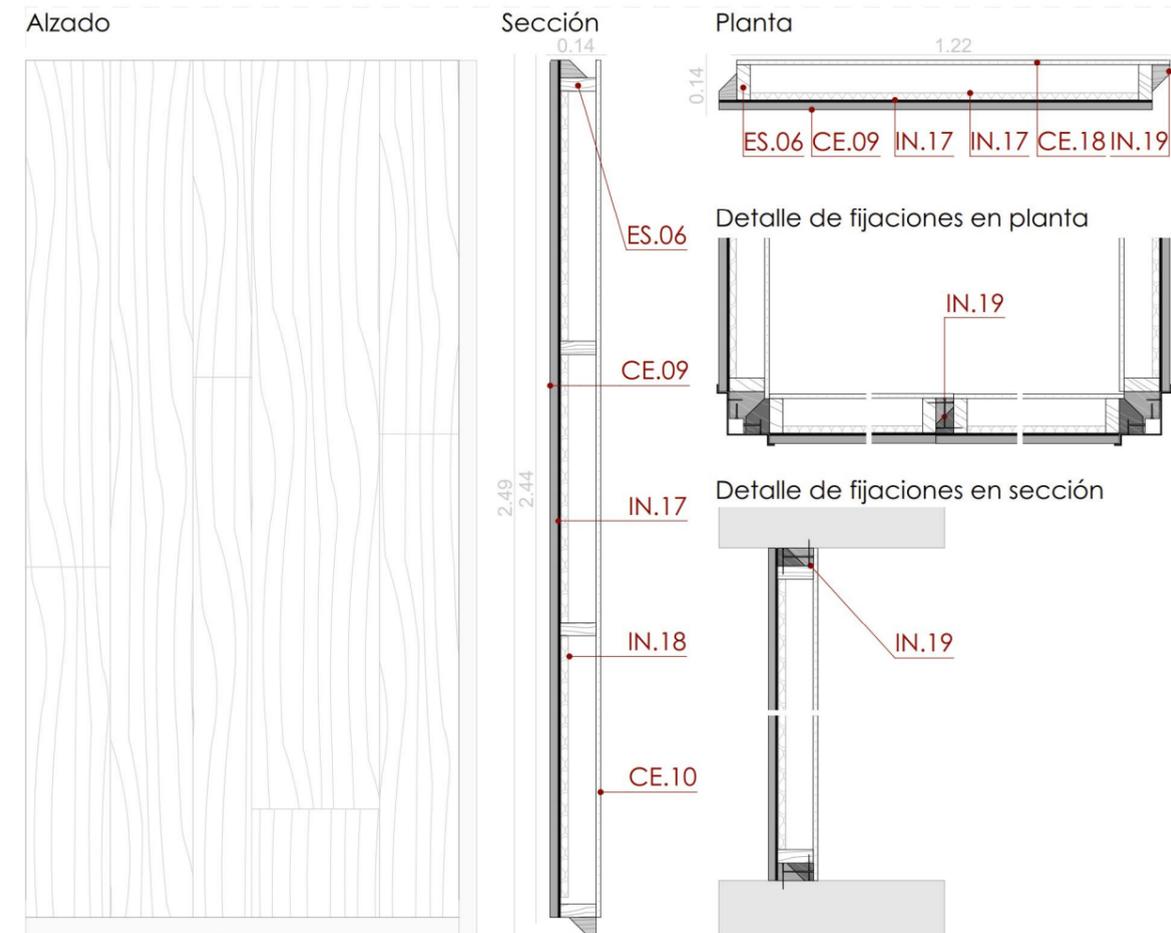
Diseño de panel de envolvente vertical para muro ciego . Fuente: Autoría propia.
